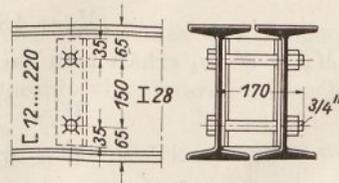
Verkopplung von Trägern durch C-Eisenstücke und Stehbolzen.
